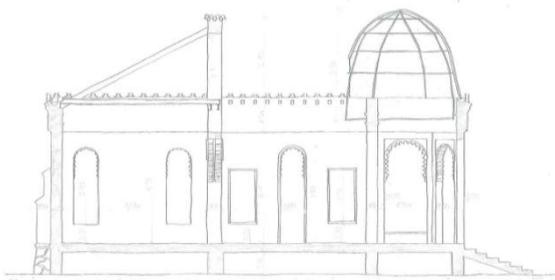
Croquis Sección Transversal (2014) - Fuente propia
